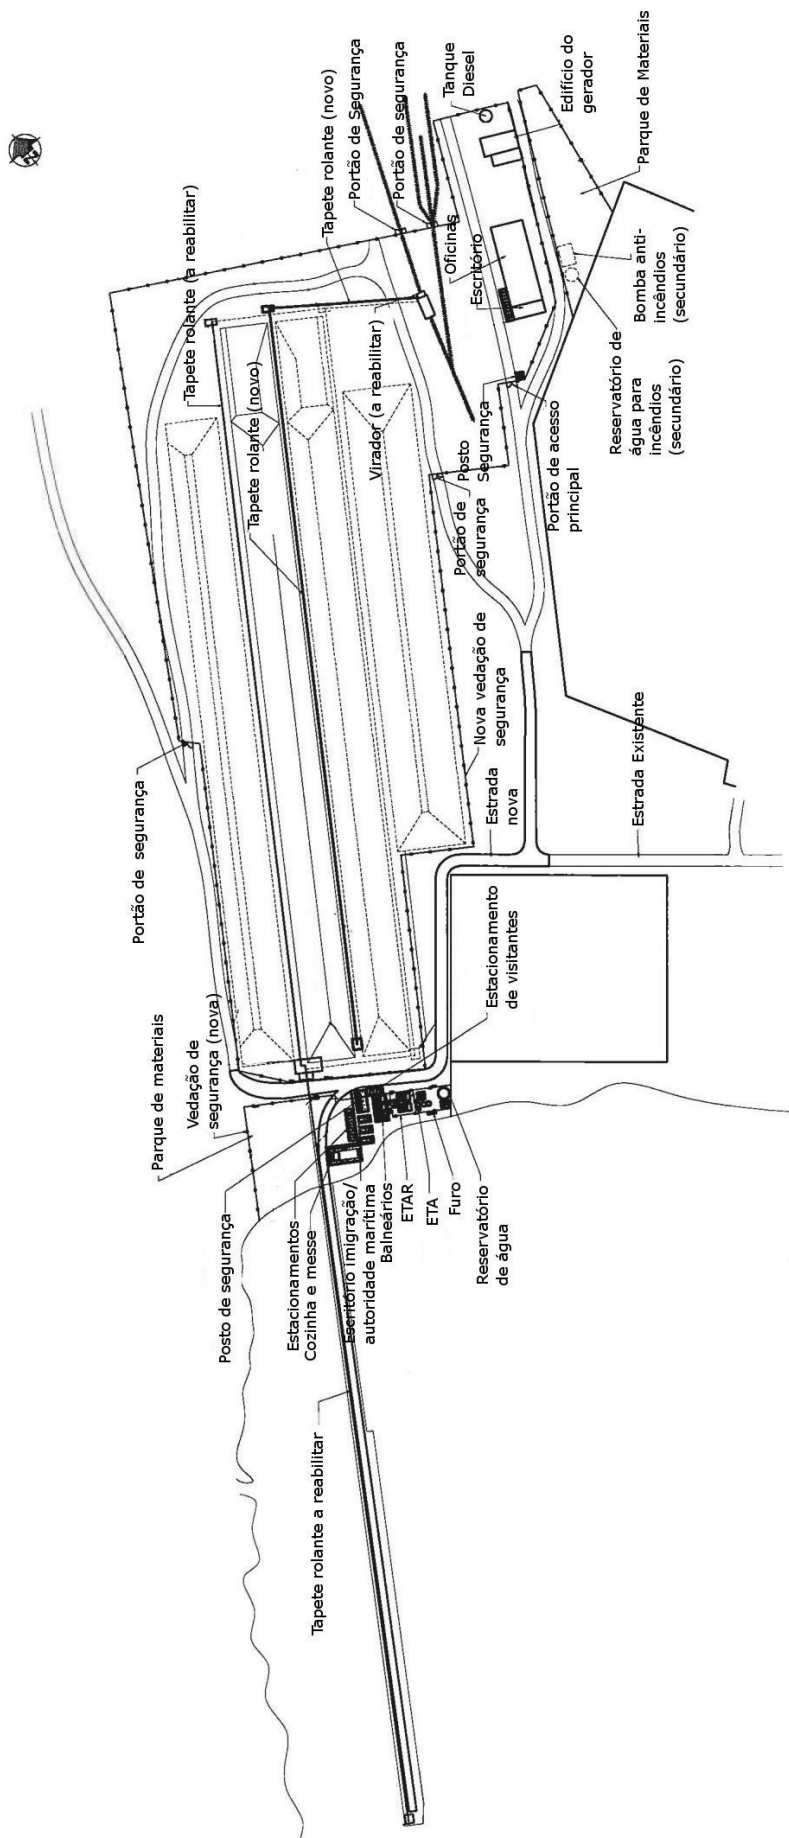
Planta esquemática das intervenções de reabilitação previstas
